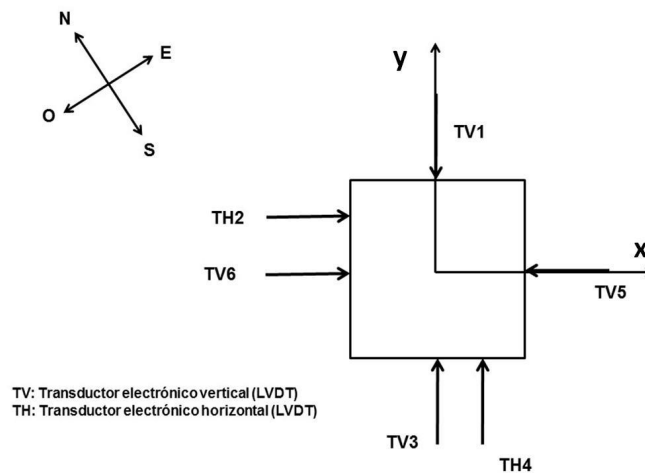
Identificación de LVDT's en la cabeza del pilote. Ensayo B
